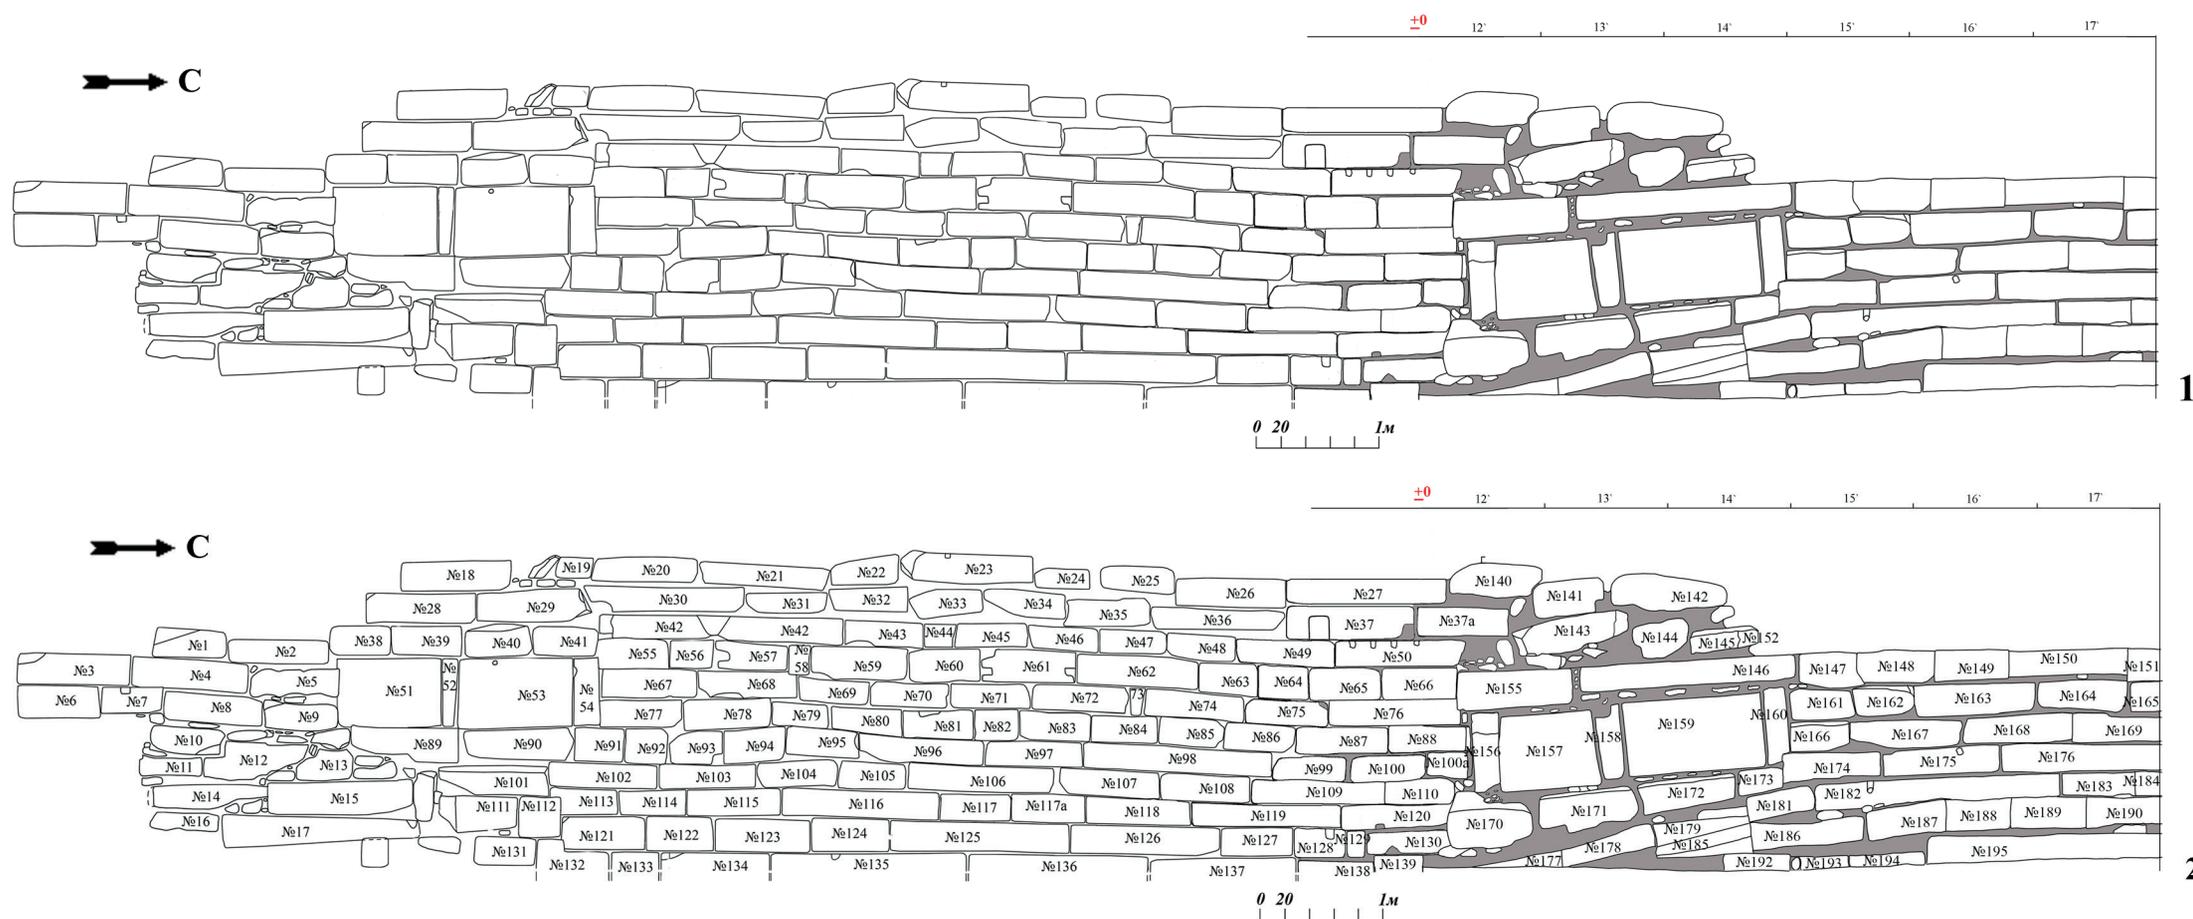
Монументальное архитектурное сооружение на р. Рубас. 1–2 – восточный фас стены №2
